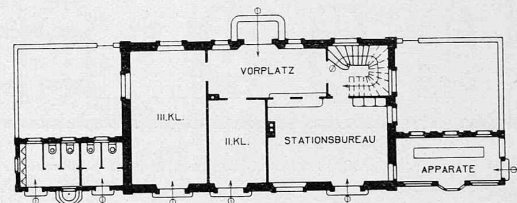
Grundriss des Bahnhofgebäudes Augst. — 1:400.
